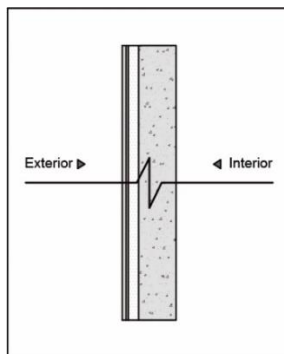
Sección esquemática sistema de aislamiento dentro del muro, elaboración propia.
